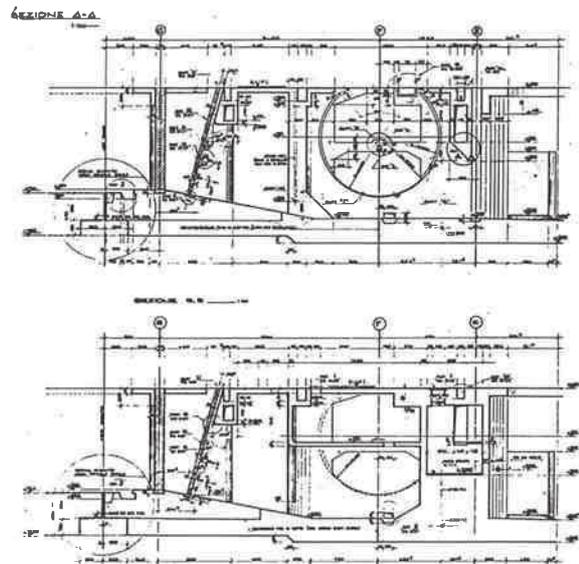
La geometria delle pareti è caratterizzata dalla variabilità delle quote di spiccatto e dagli innesti di altre strutture.
